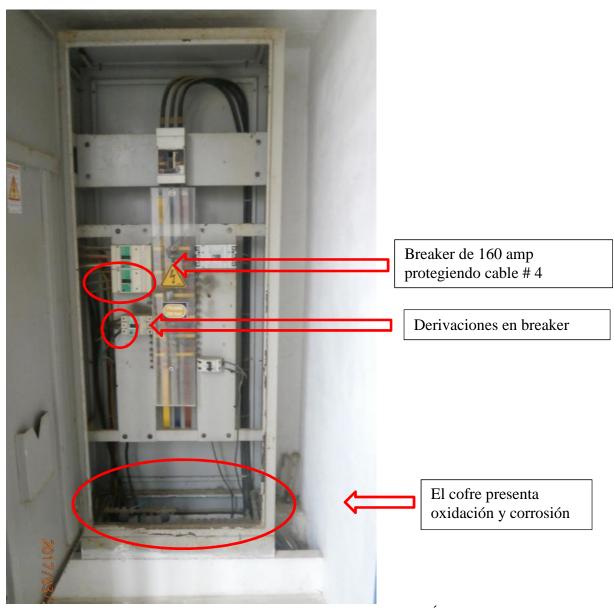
TABLERO BLOQUE DE LAVANDERÍA
